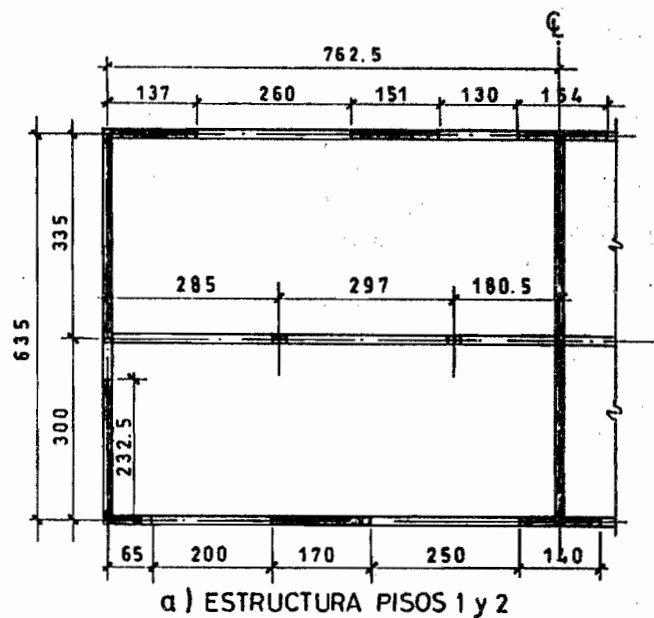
Planta de estructura de un edificio de 4 pisos de altura, con aisladores sísmicos en la base (sobre las fundaciones).
